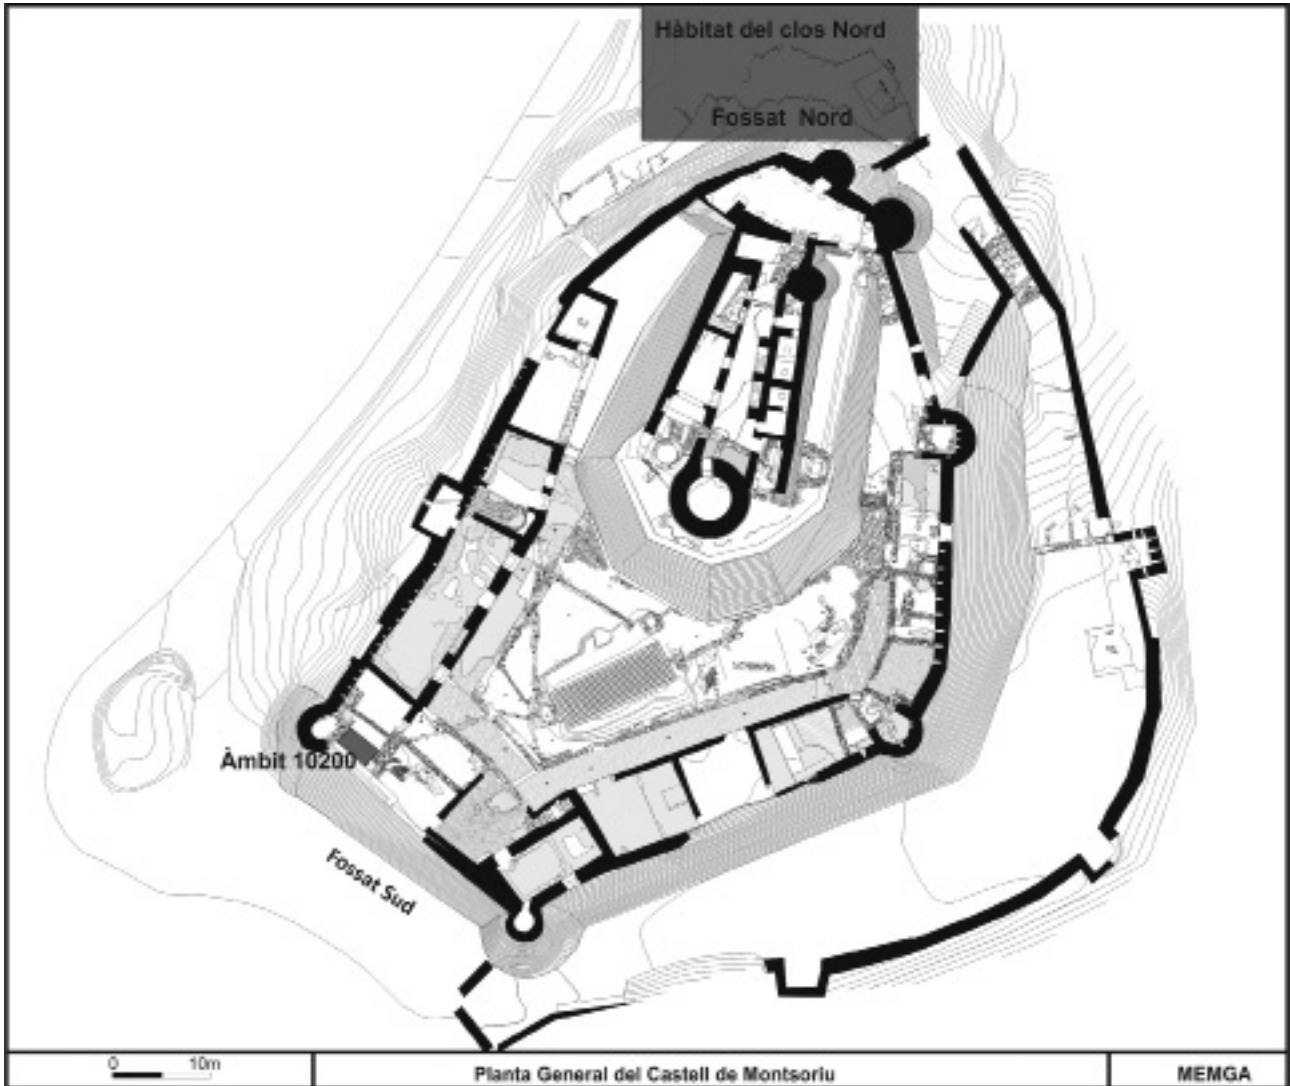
Planta arqueològica i arquitectònica de Montsoriu amb la situació dels àmbits excavats els anys 2016 i 2017.
